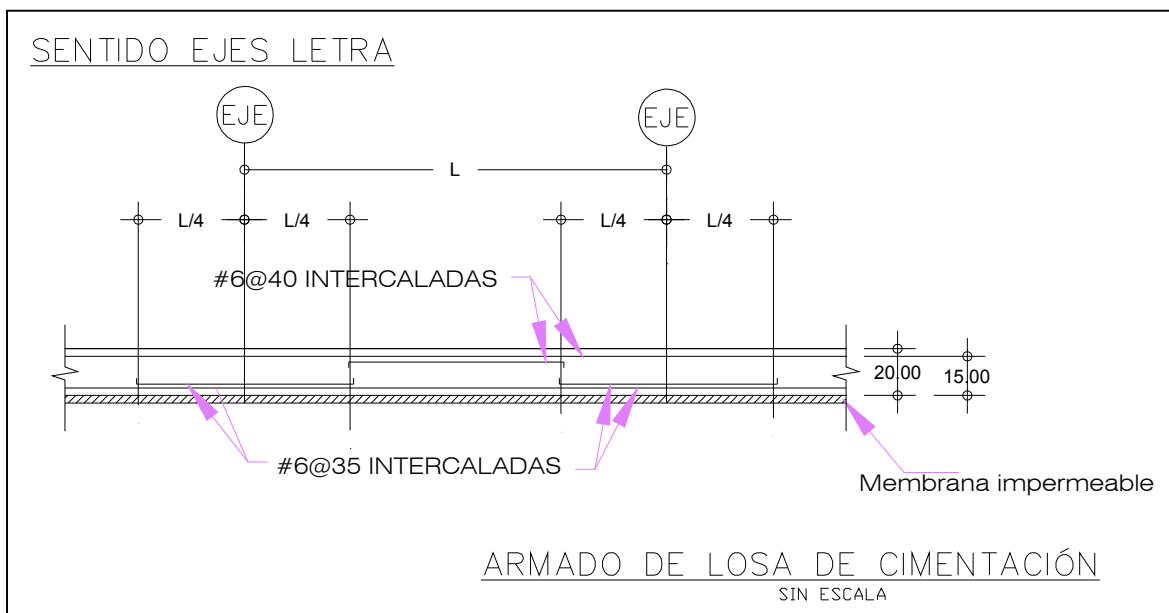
11 Detalle armado de losa en sentido de ejes letra.
